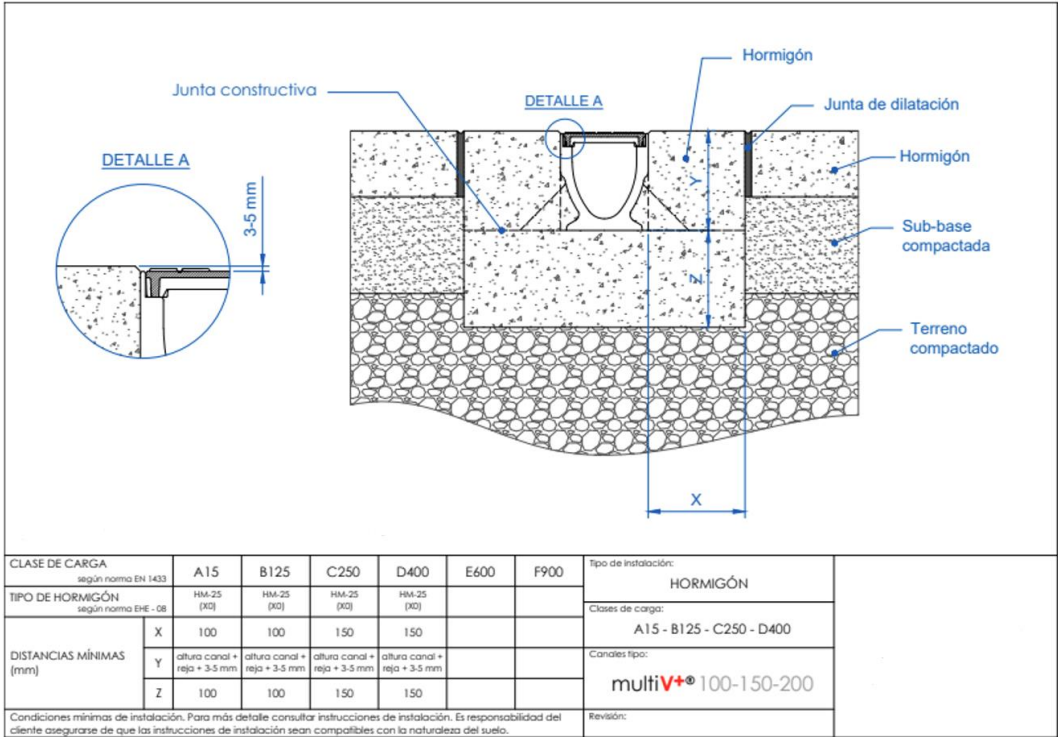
Canaleta tipo de hormigón polímero . Medidas e instalación.
